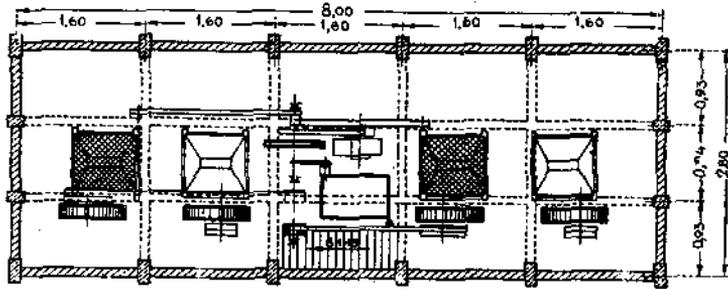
Платы этажей машинного корпуса зернового элеватора.
